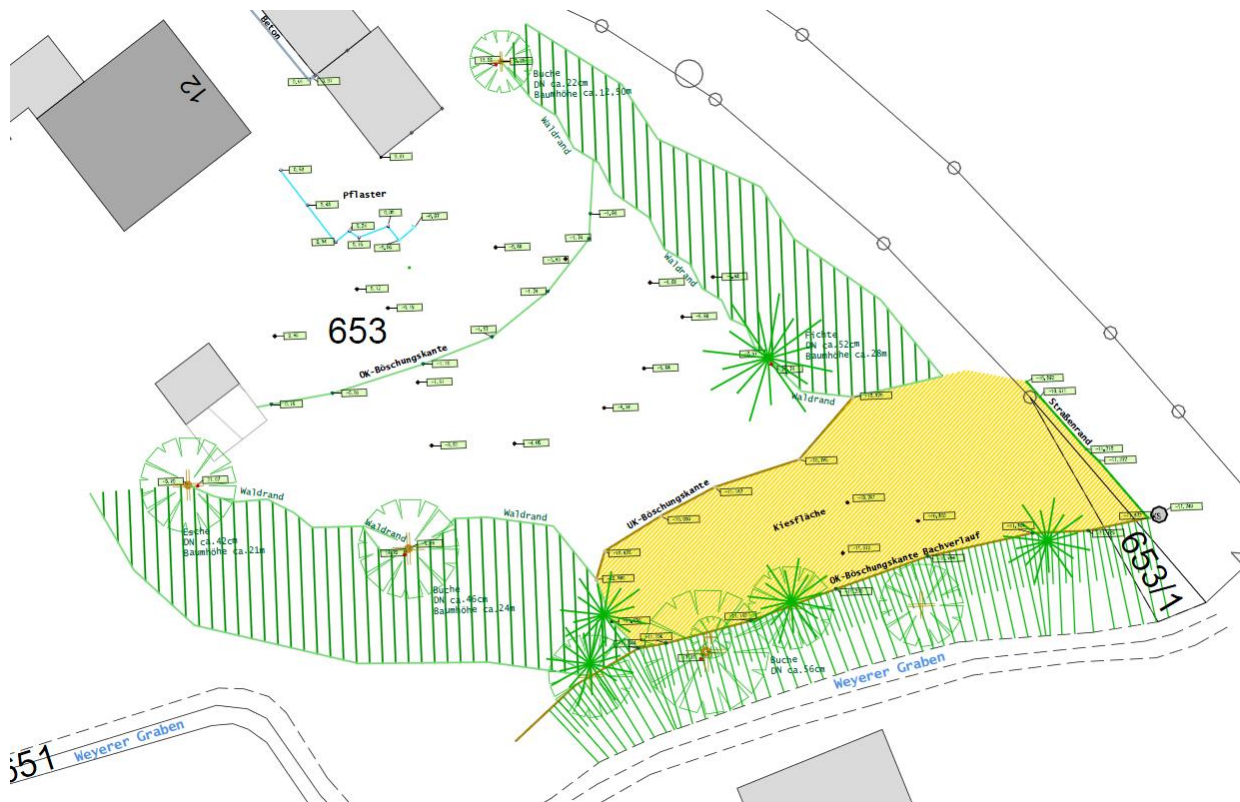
Bestandsaufmaß, Grossmann Bau GmbH & Co. KG, Rosenheim v. 07.07.2021, Waldrand grün schraffiert, Kiesfläche gelb schraffiert
